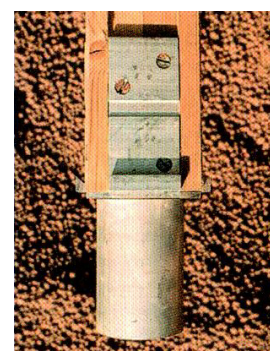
Conector metálico para encaixe, embutido nos pilares e vigas.
